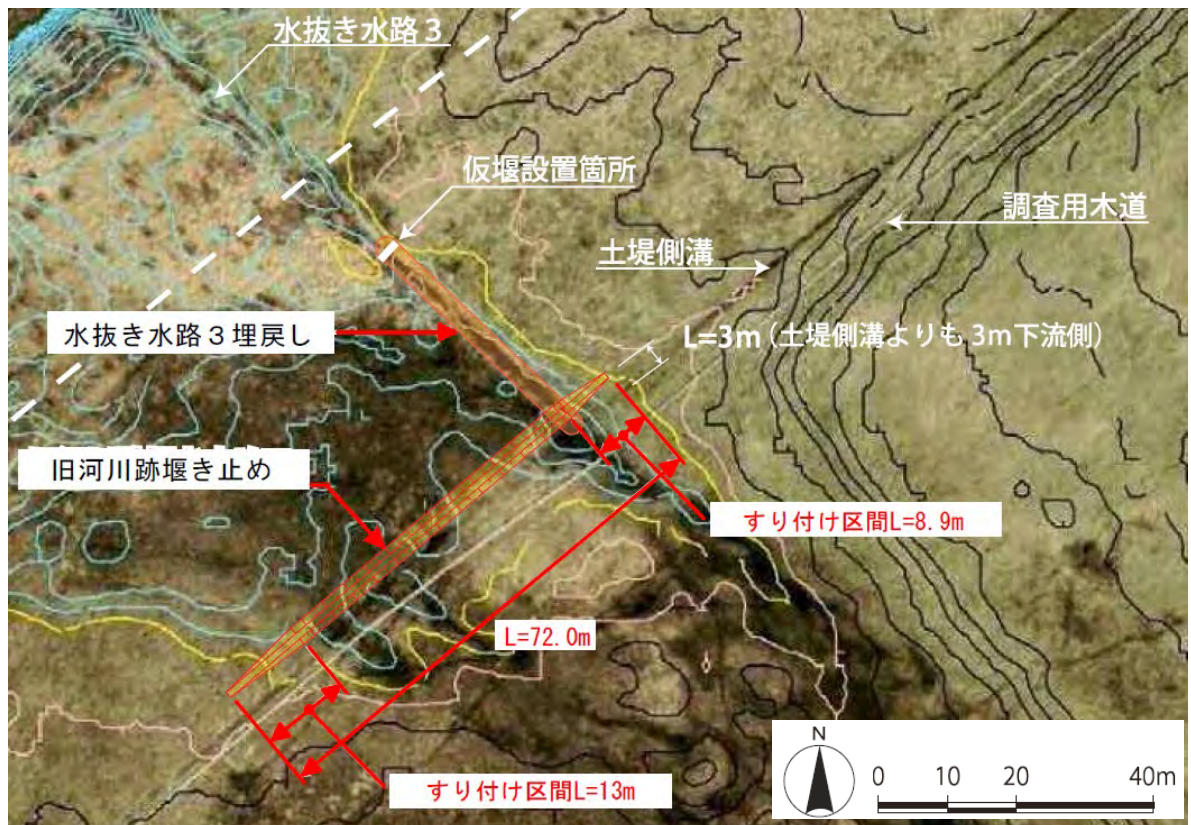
水抜き水路 3 及び旧河川跡堰き止め工完成平面図
